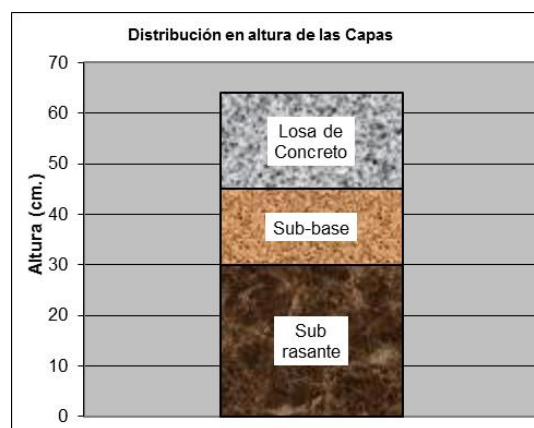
Diseño de pavimento rígido, muestra patrón con adición 0.9% FN y 6.5% CM. E=190 mm
